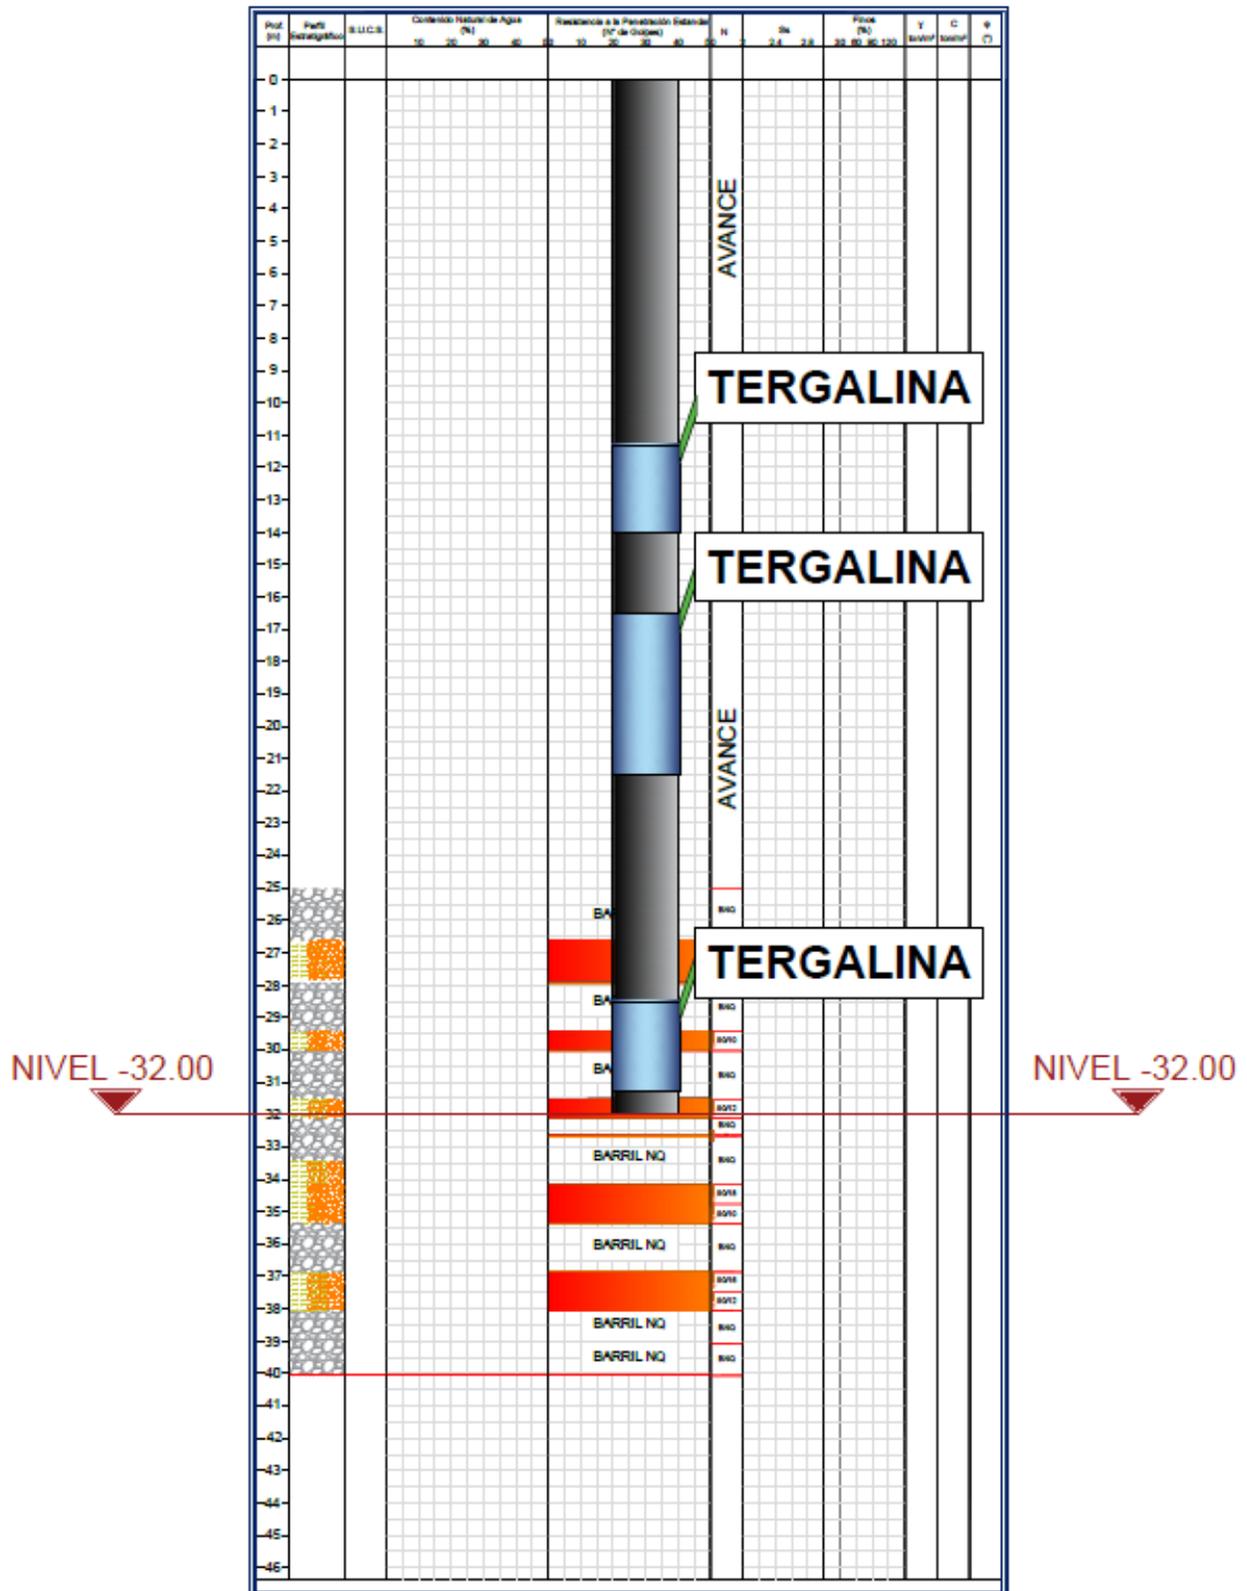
PILA 5 (SM-5 EJE E3).
